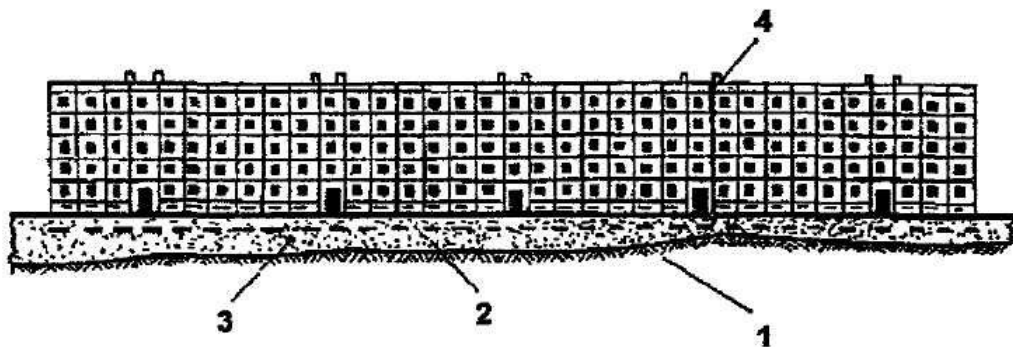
Схема деформации крупнопанельного жилого дома при сильной неравномерной деформации грунтового основания в результате его замачивания:
